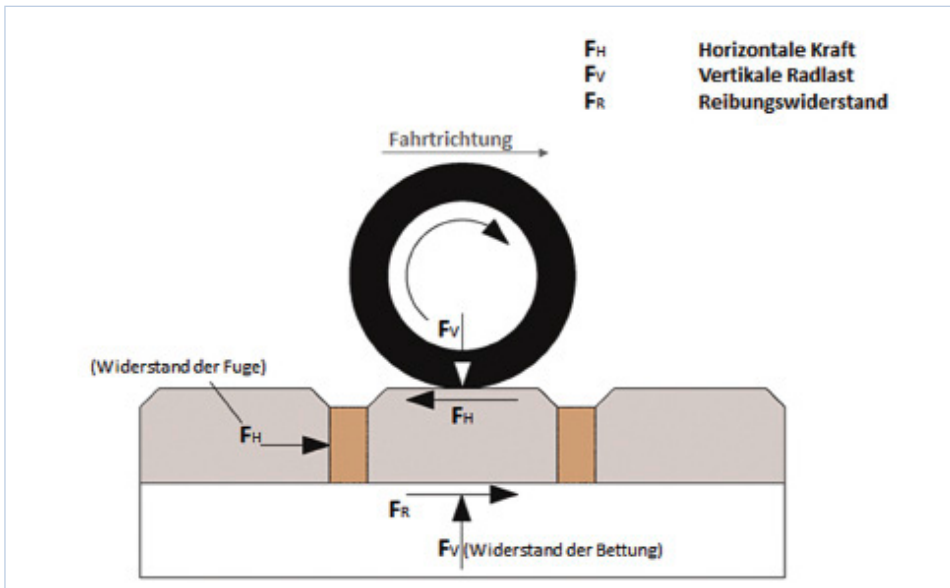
Pflasterfläche mit rollender Radlast (vertikale und horizontale Kraft) [Quelle: Buchholz]
